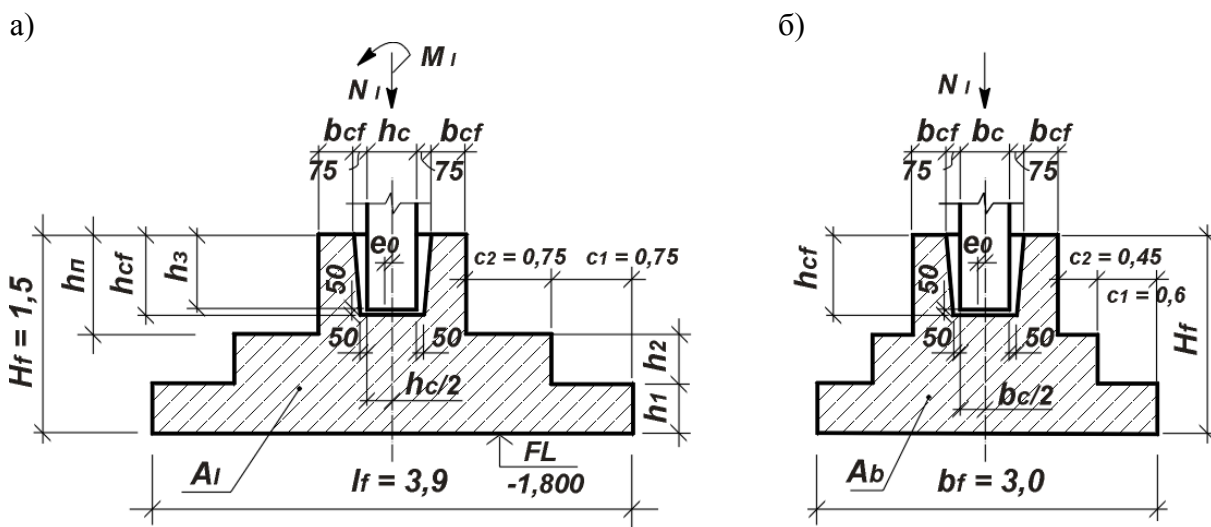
К расчету плитной части фундамента на раскалывание:
